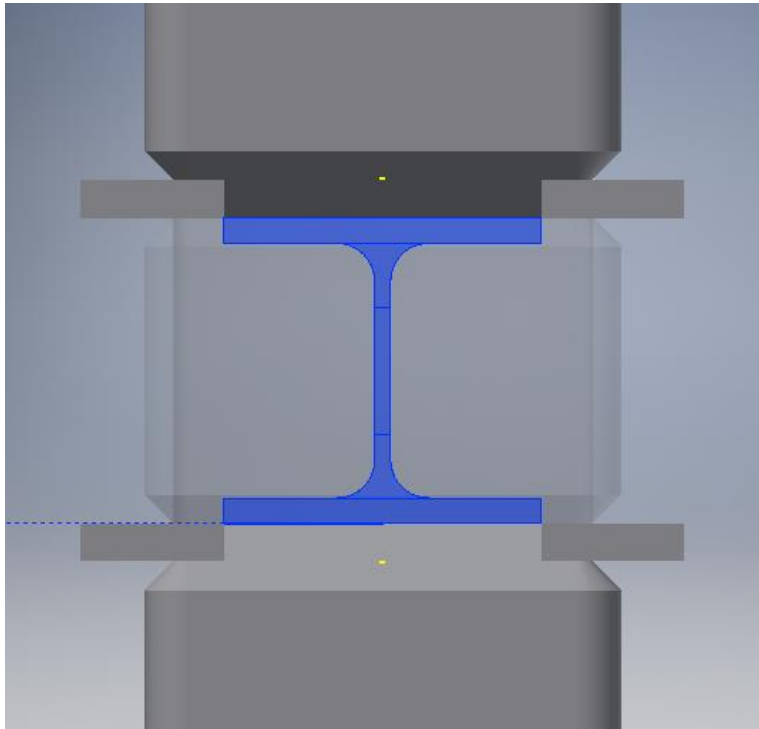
Perfil de conexión visto desde la sección transversal de la viga. Cordones de soldadura ocultos
